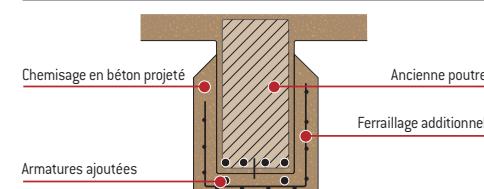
Exemple de renforcement d'une poutre par béton projeté [coupe transversale]
